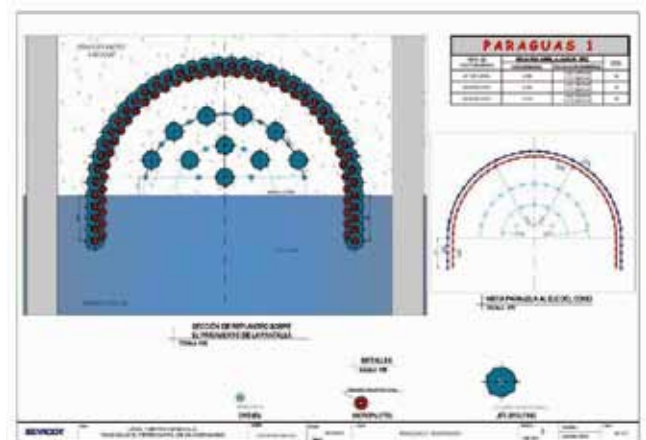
Paraguas de jet-grouting y de micropilotes. Sección transversal
